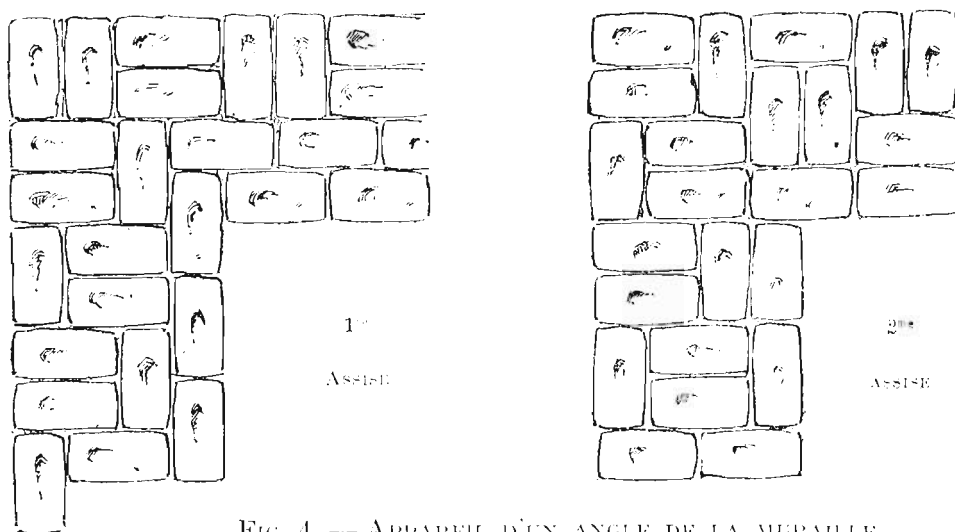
APPAREIL D'UN ANGLE DE LA MURAILLE
